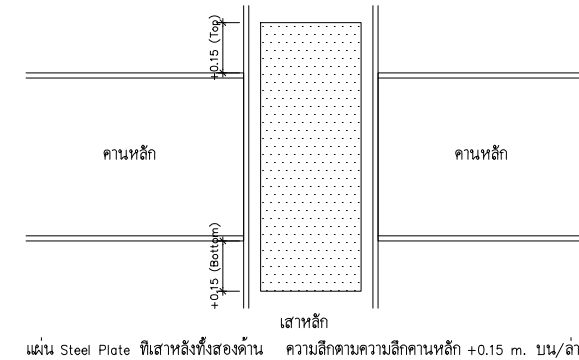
แบบแสดงการเสริม Stiffener Steel ที่เสาหลักทั้งสองด้าน
